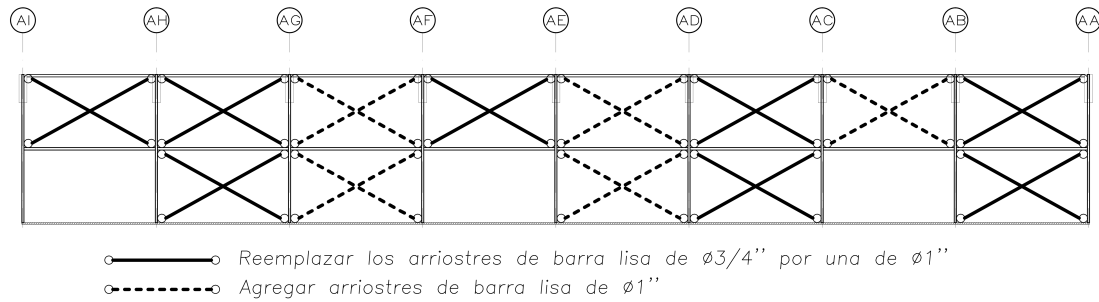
Propuesta de reforzamiento de la estructura en la dirección Y, Eje 1
